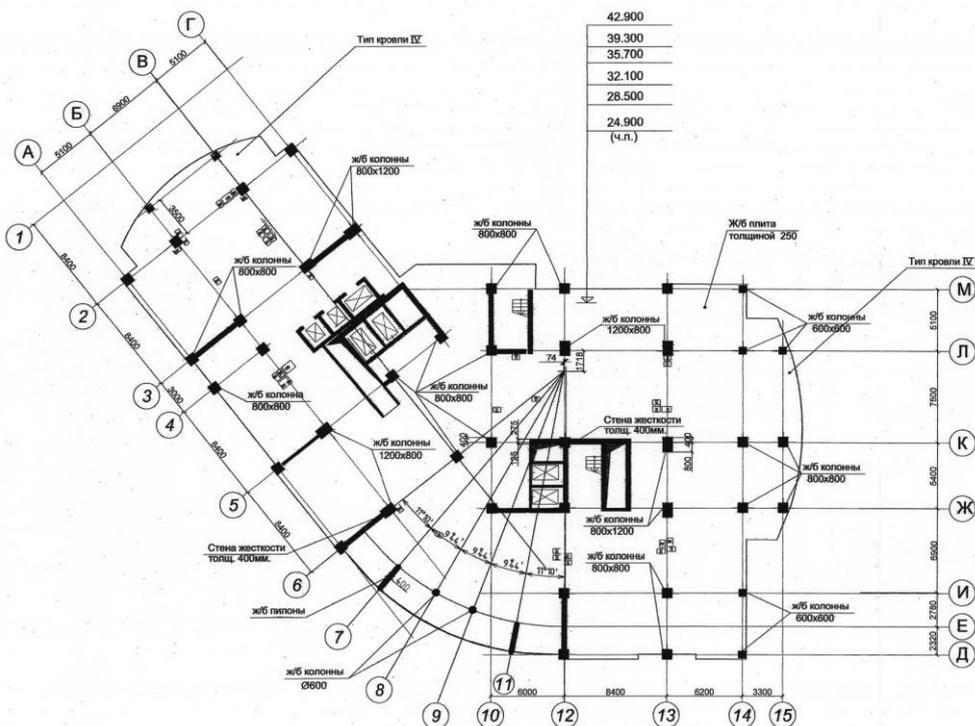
План конструкций с 8 по 13 этажи на отм. 24.900÷42.900 (ч.п.) высотного здания
